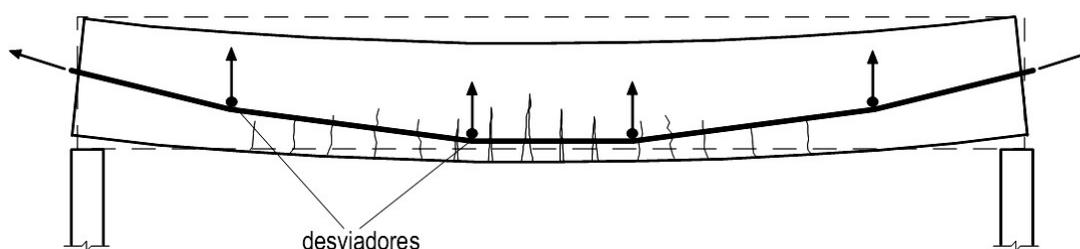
Protensão externa sem aderência para reforço de vigas de pontes. (Fonte: VERÍSSIMO, 1988).
